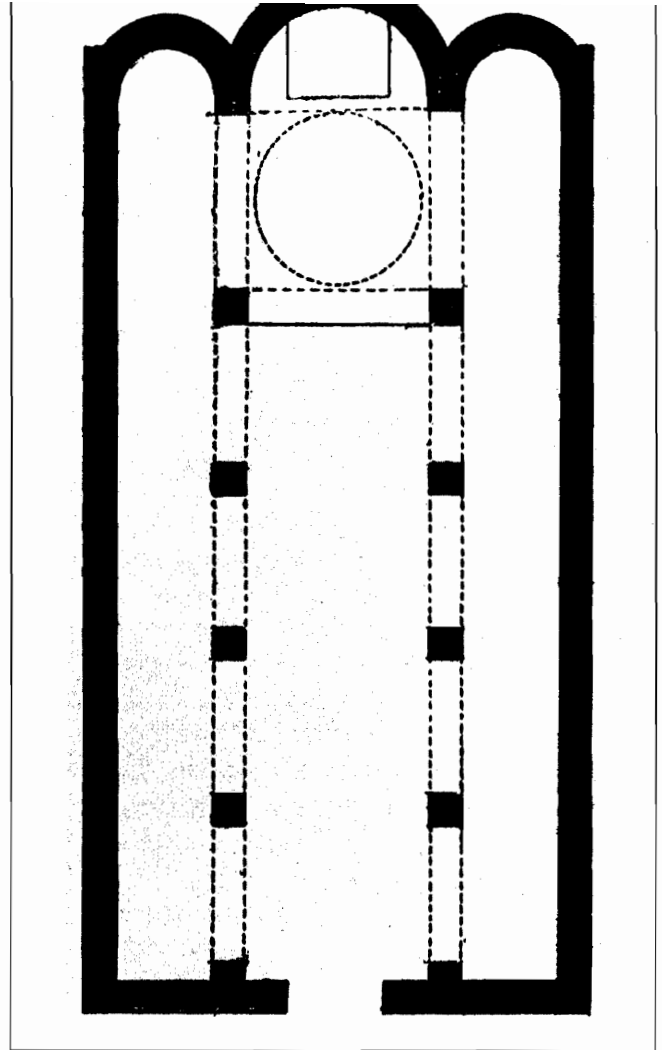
Santa Maria di Terreti. Planimetria (Orsi-Carta, ante 1915)
